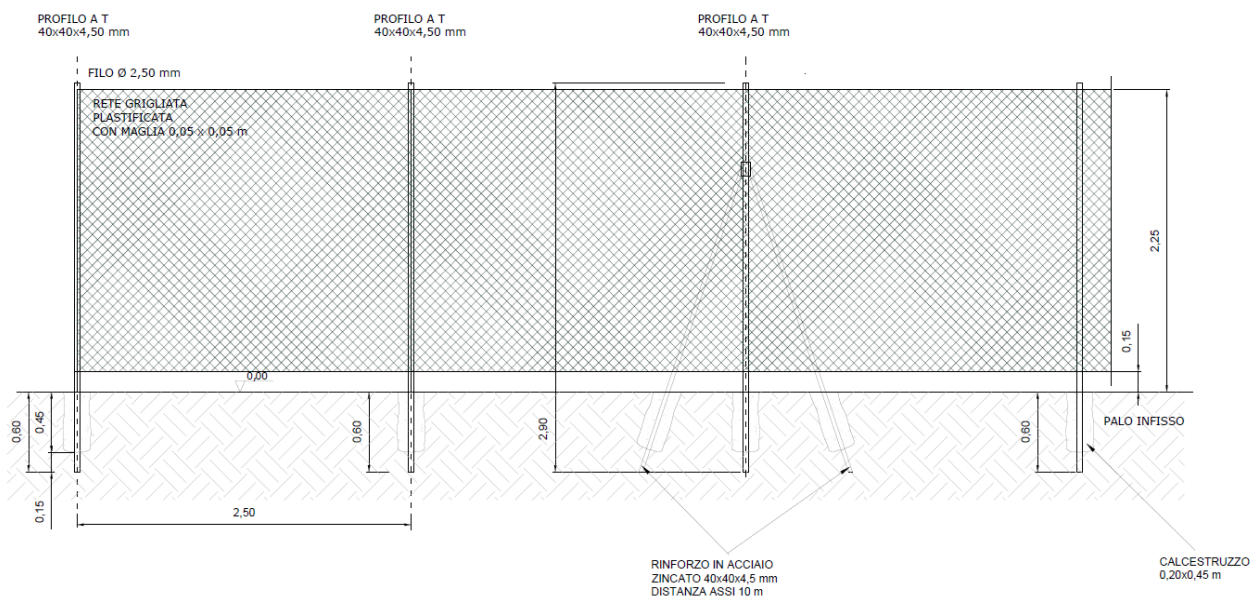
recinzione perimetrale, sollevata di 15 cm dal suolo per il passaggio della piccola fauna.
